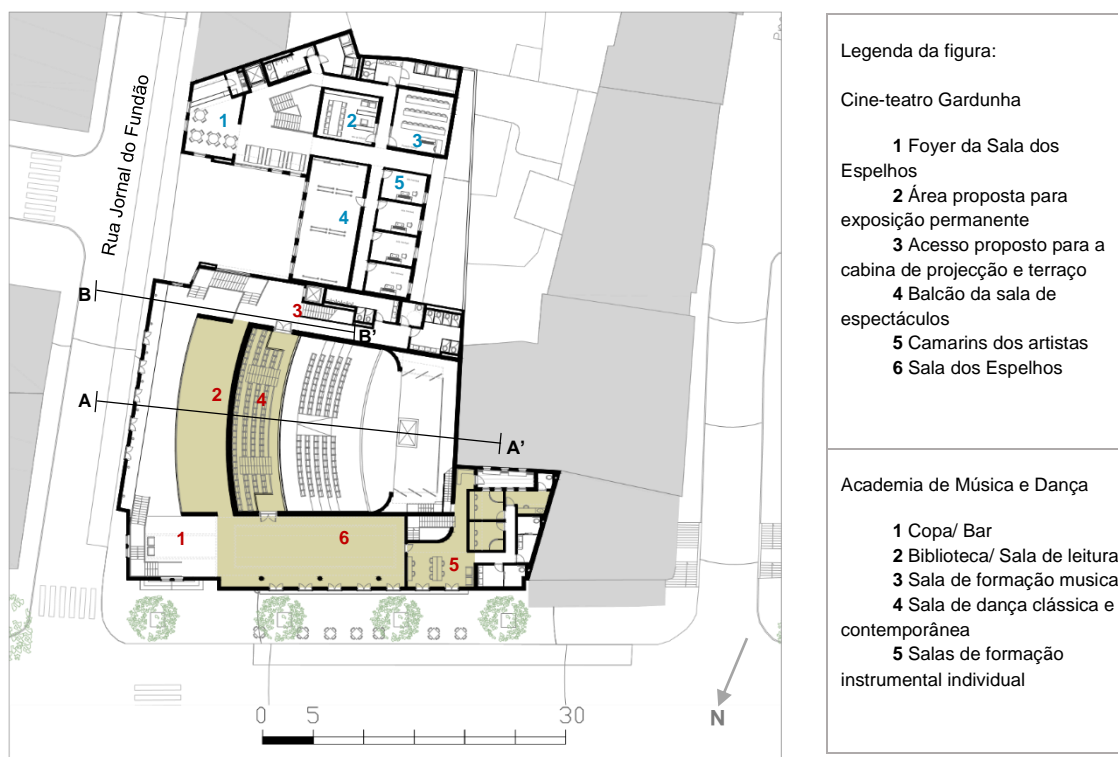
Planta do primeiro piso da proposta para o Cine-teatro Gardunha e Academia de Música e Dança do Fundão.
